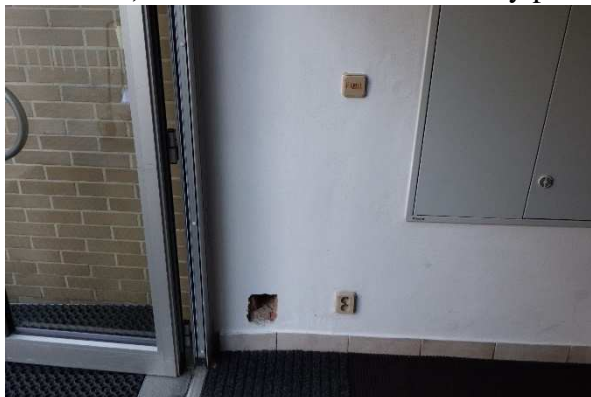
sonda NS-A3 –obnažená část; Foto č.74--sonda NS-A4 – celkový pohled;
